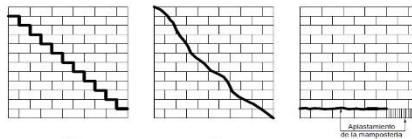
Modos de falla de la mampostería no reforzada sometida a cargas en su plano.
